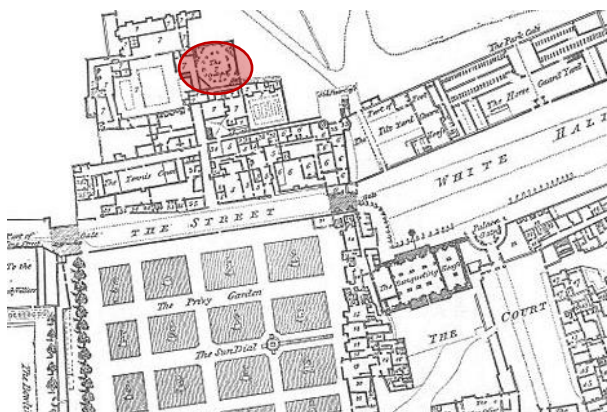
Planta do *White Hall*, Londres<sup>56</sup>
